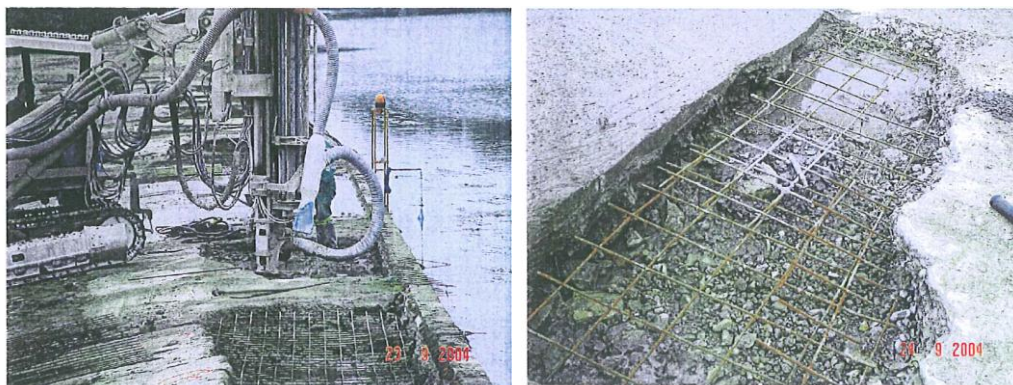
Photographies des travaux de 2004 (même type de travaux sur ce barrage)
